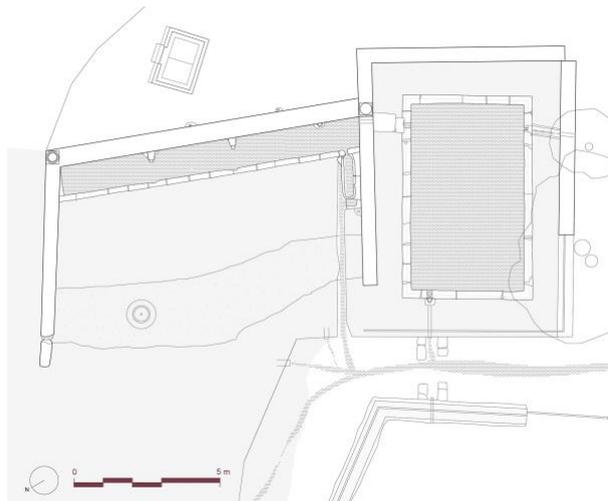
Planta del conjunto de la fuente y el lavadero antes de la intervención.
